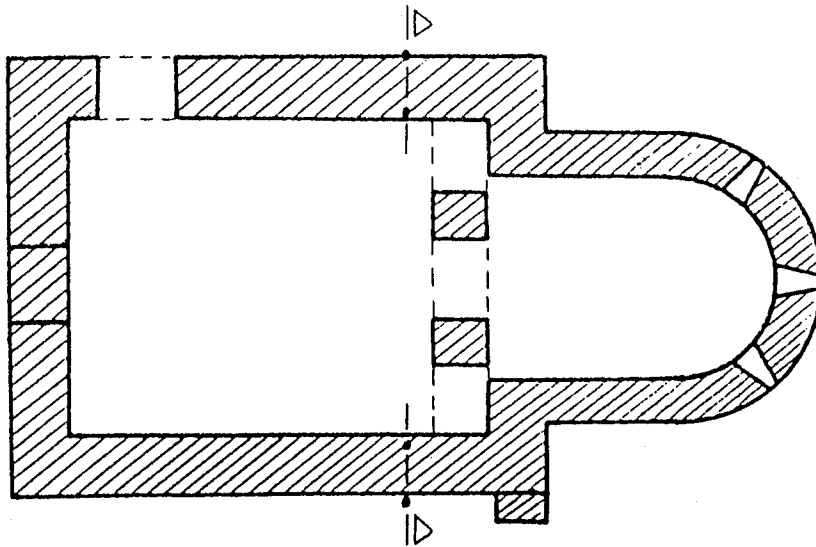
Planta de la ermita de San Esteban de Viguera.
